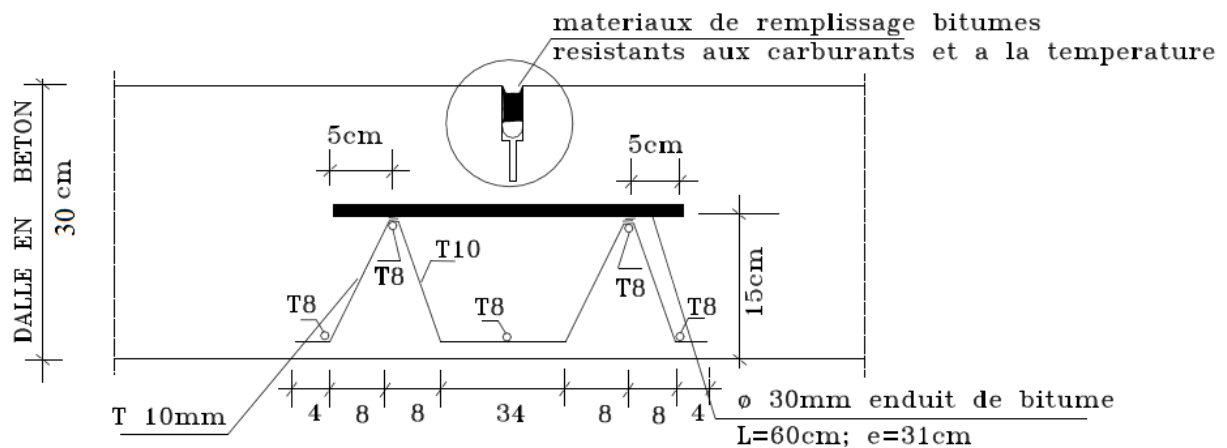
Joint transversal avec goujons utiliser au long de la piste renforcée.
